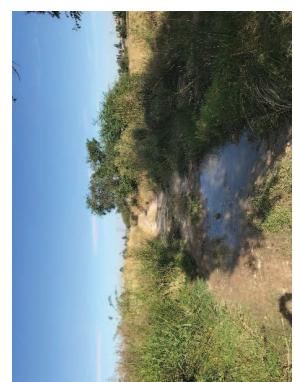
vista panorámica de un tramo de camino rural con vegetación y un horizonte lejano.
